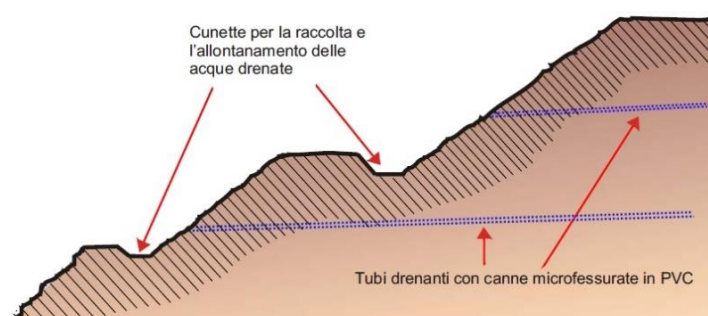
Sistema di drenaggio profondo realizzato con una rete di dreni suborizzontali.
